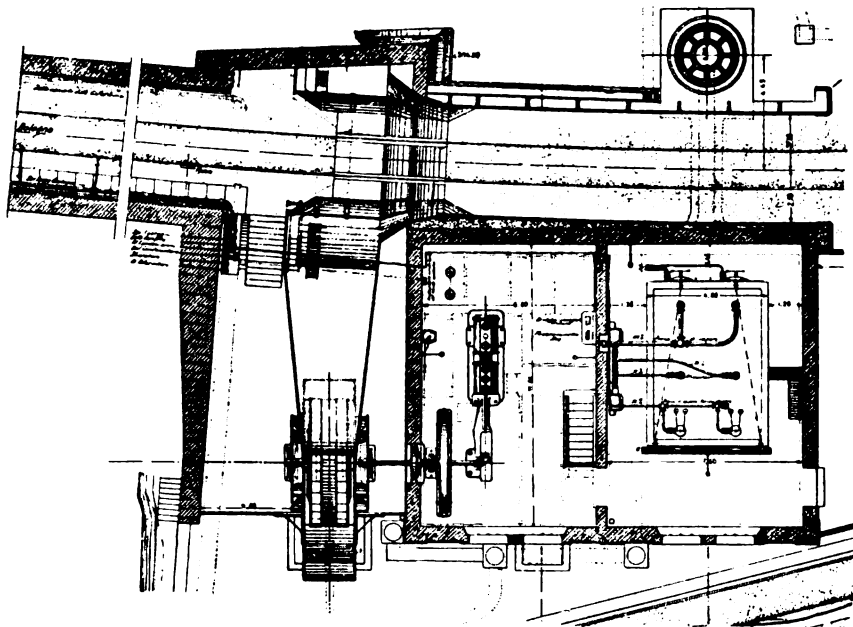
Officina per la ventilazione della galleria di Piteccio - Pianta
